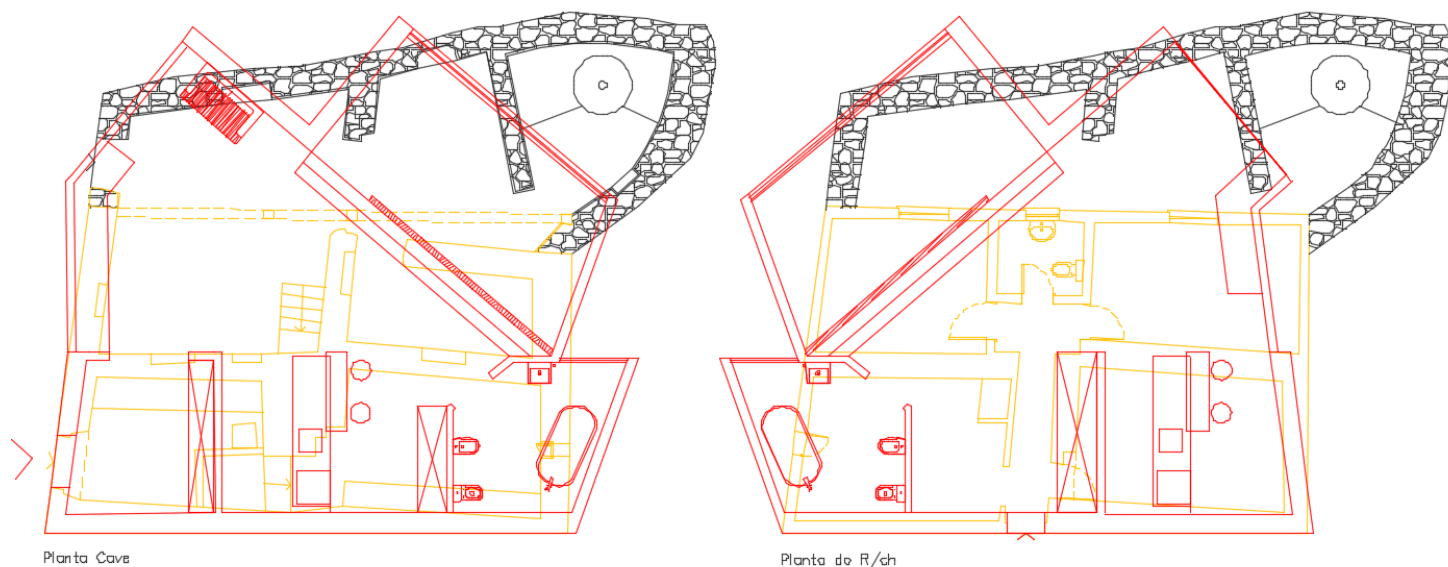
Casa 1: Planta de Trabalhos – Cave e R/Chão respetivamente. Esboço 4
